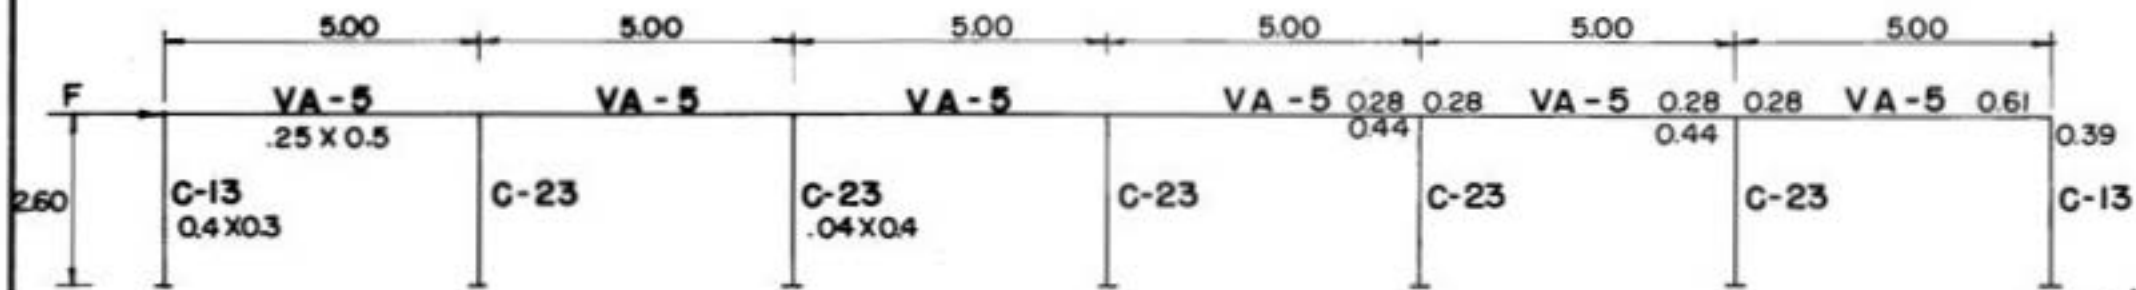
CALCULO DE LA VIGA VA-5 FUERZAS HORIZONTALES
